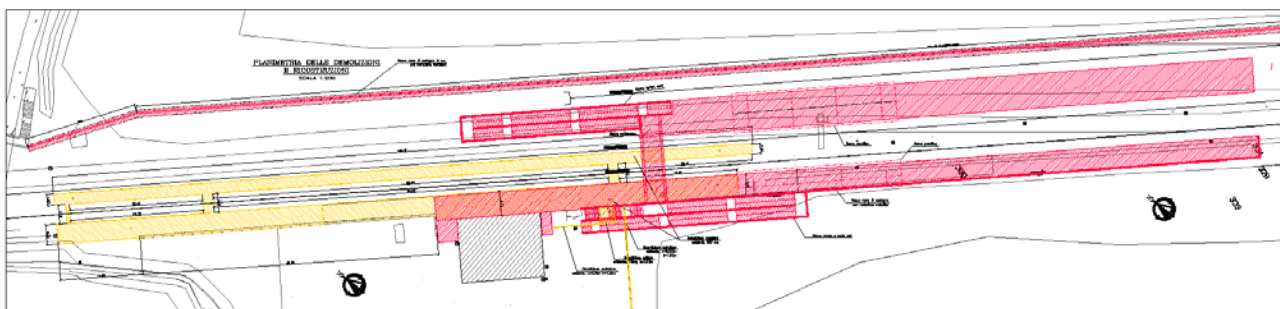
Planimetria delle demolizioni e ricostruzioni (in giallo demolizioni, in rosso ricostruzioni)
